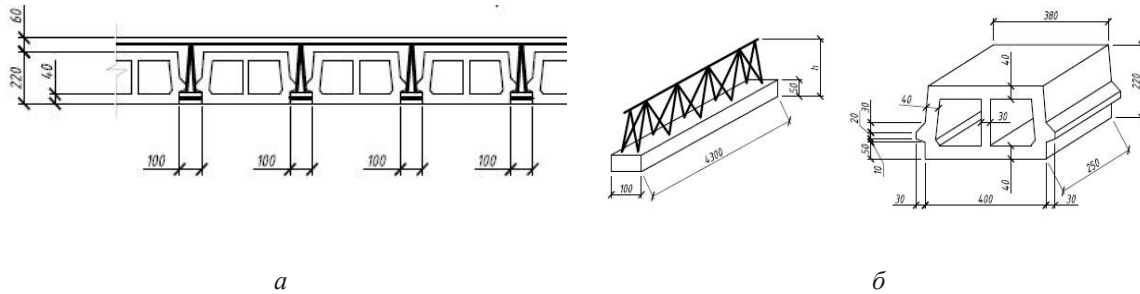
Перекриття зі збірних залізобетонних балок із вкладишами з шлакоблоків:
